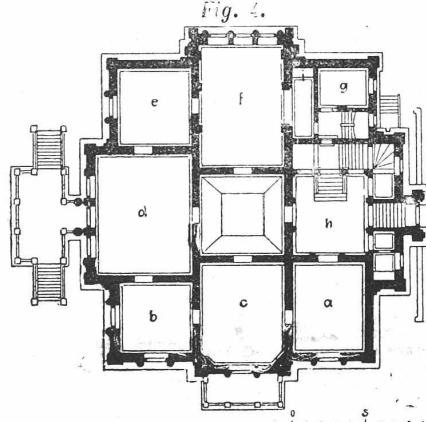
Grundplan vom Wohnhaus „Parkstrasse Nr. 2“
